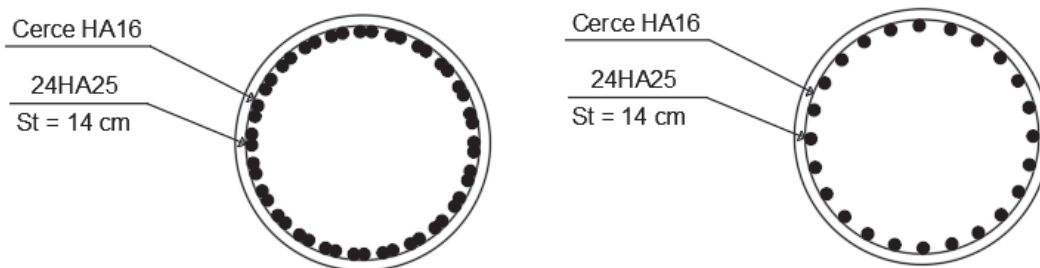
Le ferrailage longitudinal vu en plan dans les deux zones
